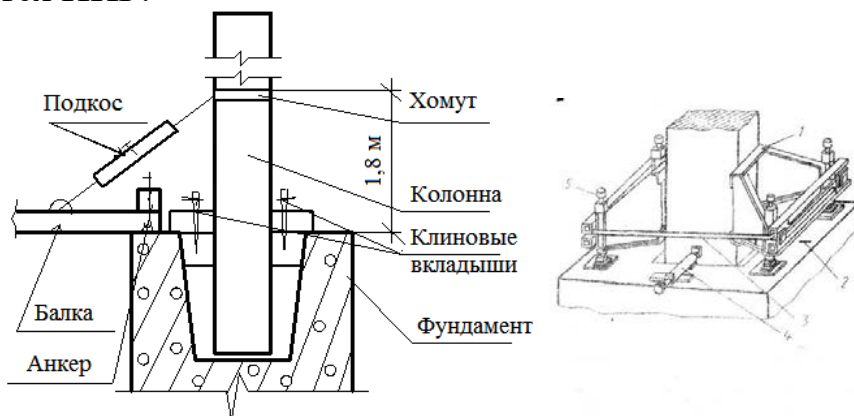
Инвентарный клиновой вкладыш для крепления железобетонных колонн
